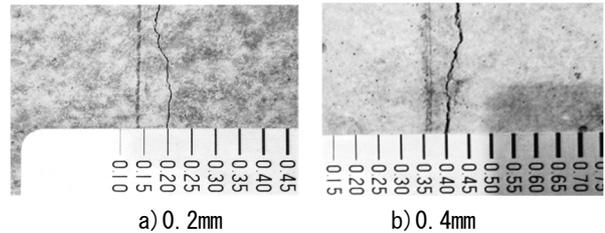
供試体ひび割れ面に導入したひび割れ状況
